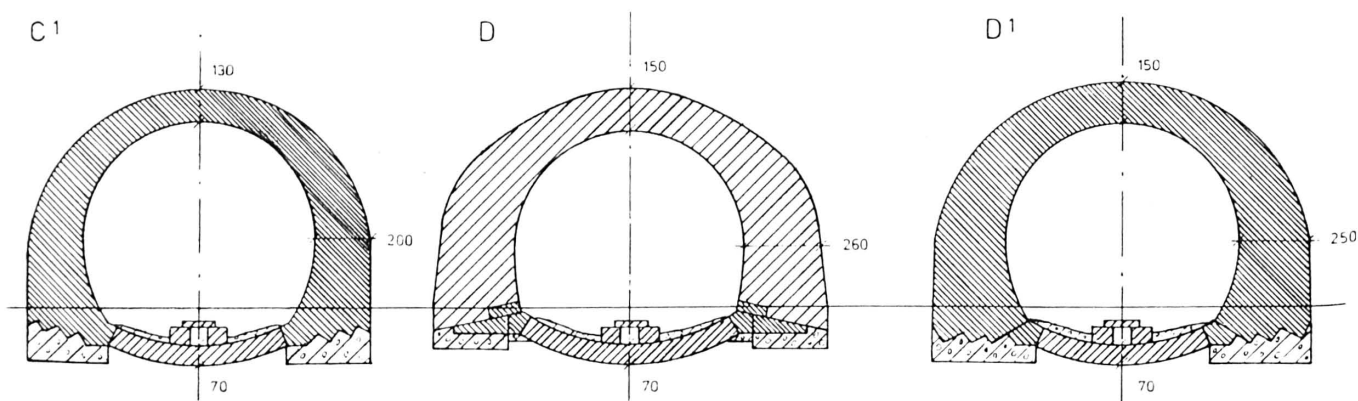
Schwere Profile der zweiten Rekonstruktion in der Druckstrecke des Bahntunnels (Lage siehe Figur 10). Die Gewölbemauerung erfolgte mit zugehauenen Bruchsteinen.
